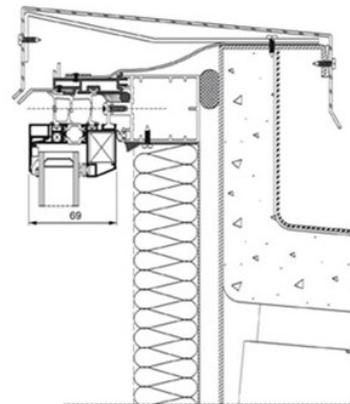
Détail de fixation du mur rideau ¹³⁵
